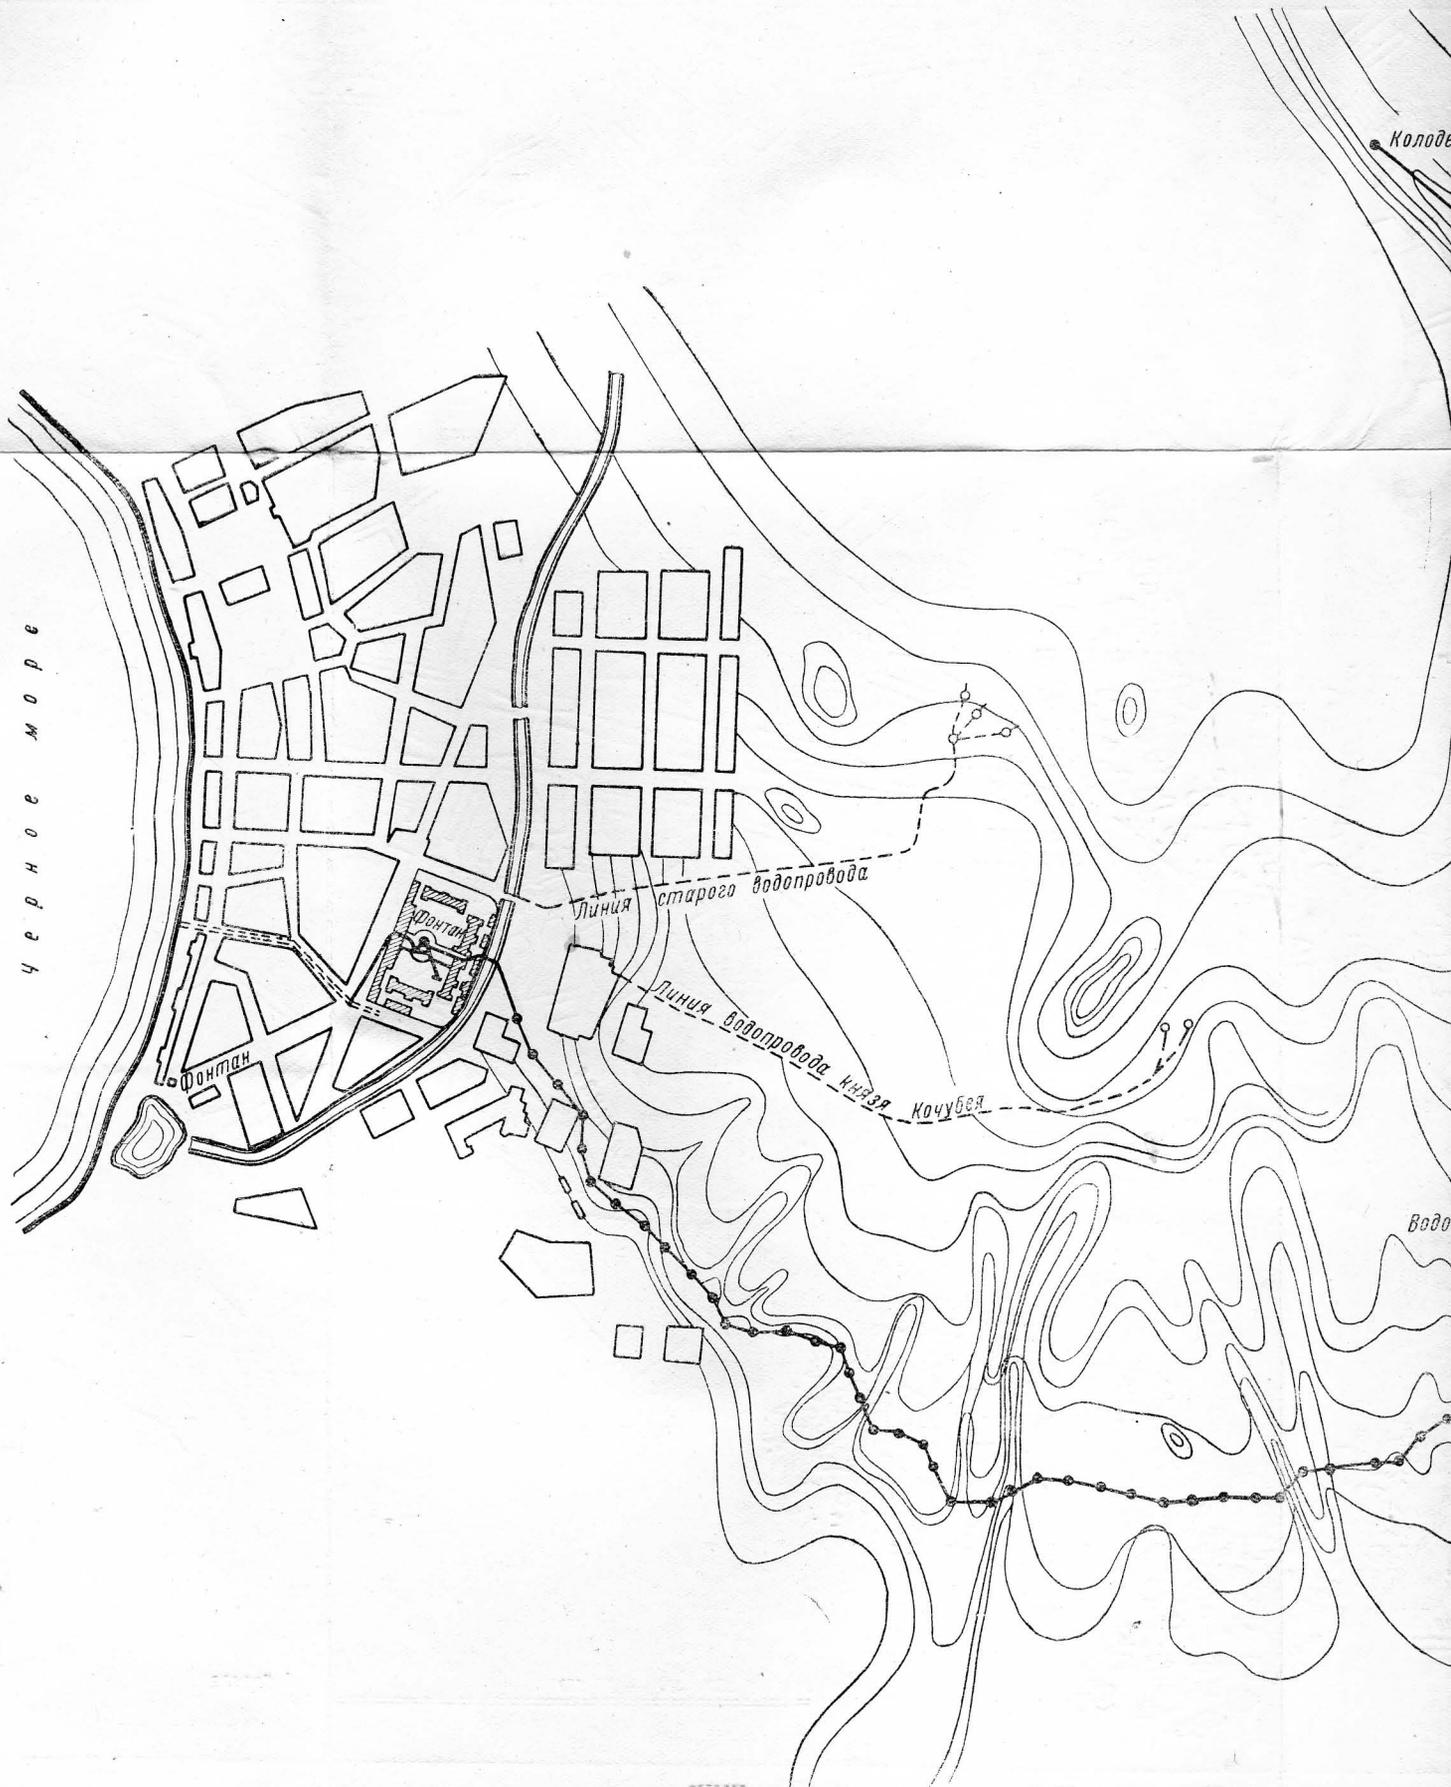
План водопровода Феодосийских казарм и древних водопроводов. («Инж. журн.», 1866 г.).
